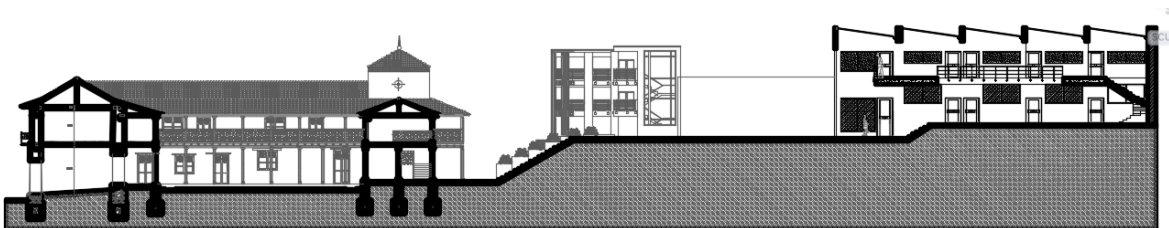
, Corte longitudinal, Fuente: Autor propio, 2016.
